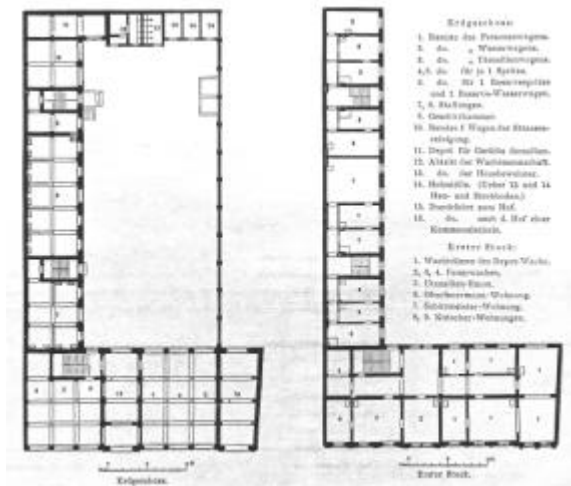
Depotgebäude Luisenstadt, Berlin, 1866, Grundrisse EG und 1. OG (aus: Klaus K. Weber, Berlin und seine Bauten, Bd. X, Berlin u.a. 1976, 15, Abb. 23)
